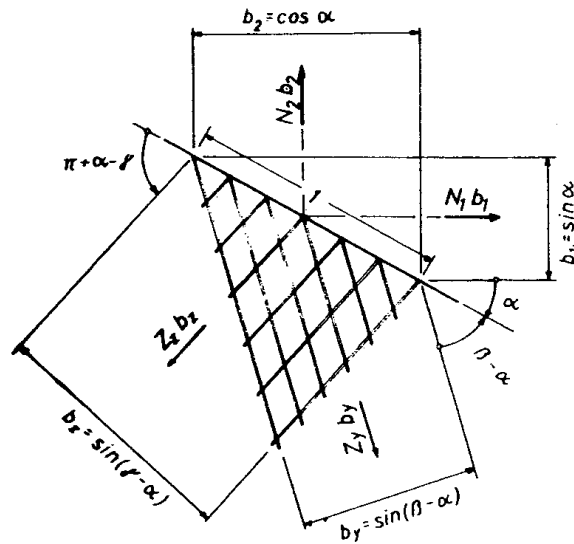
Schnitt parallel zur Bewehrungsschar in Richtung x
